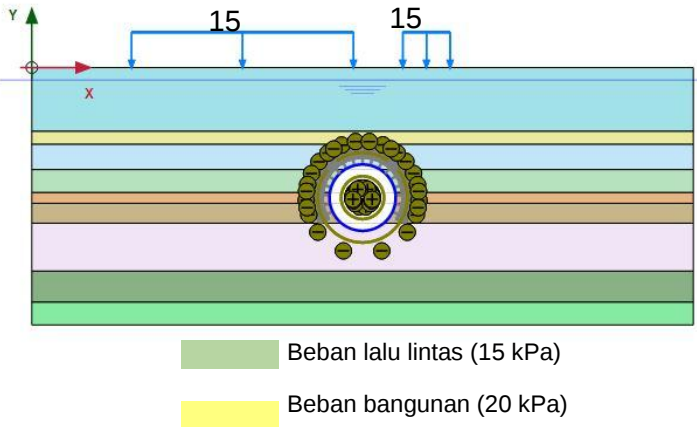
Tahapan konstruksi tunnel TBM di DK2+823.23 (potongan 4)
